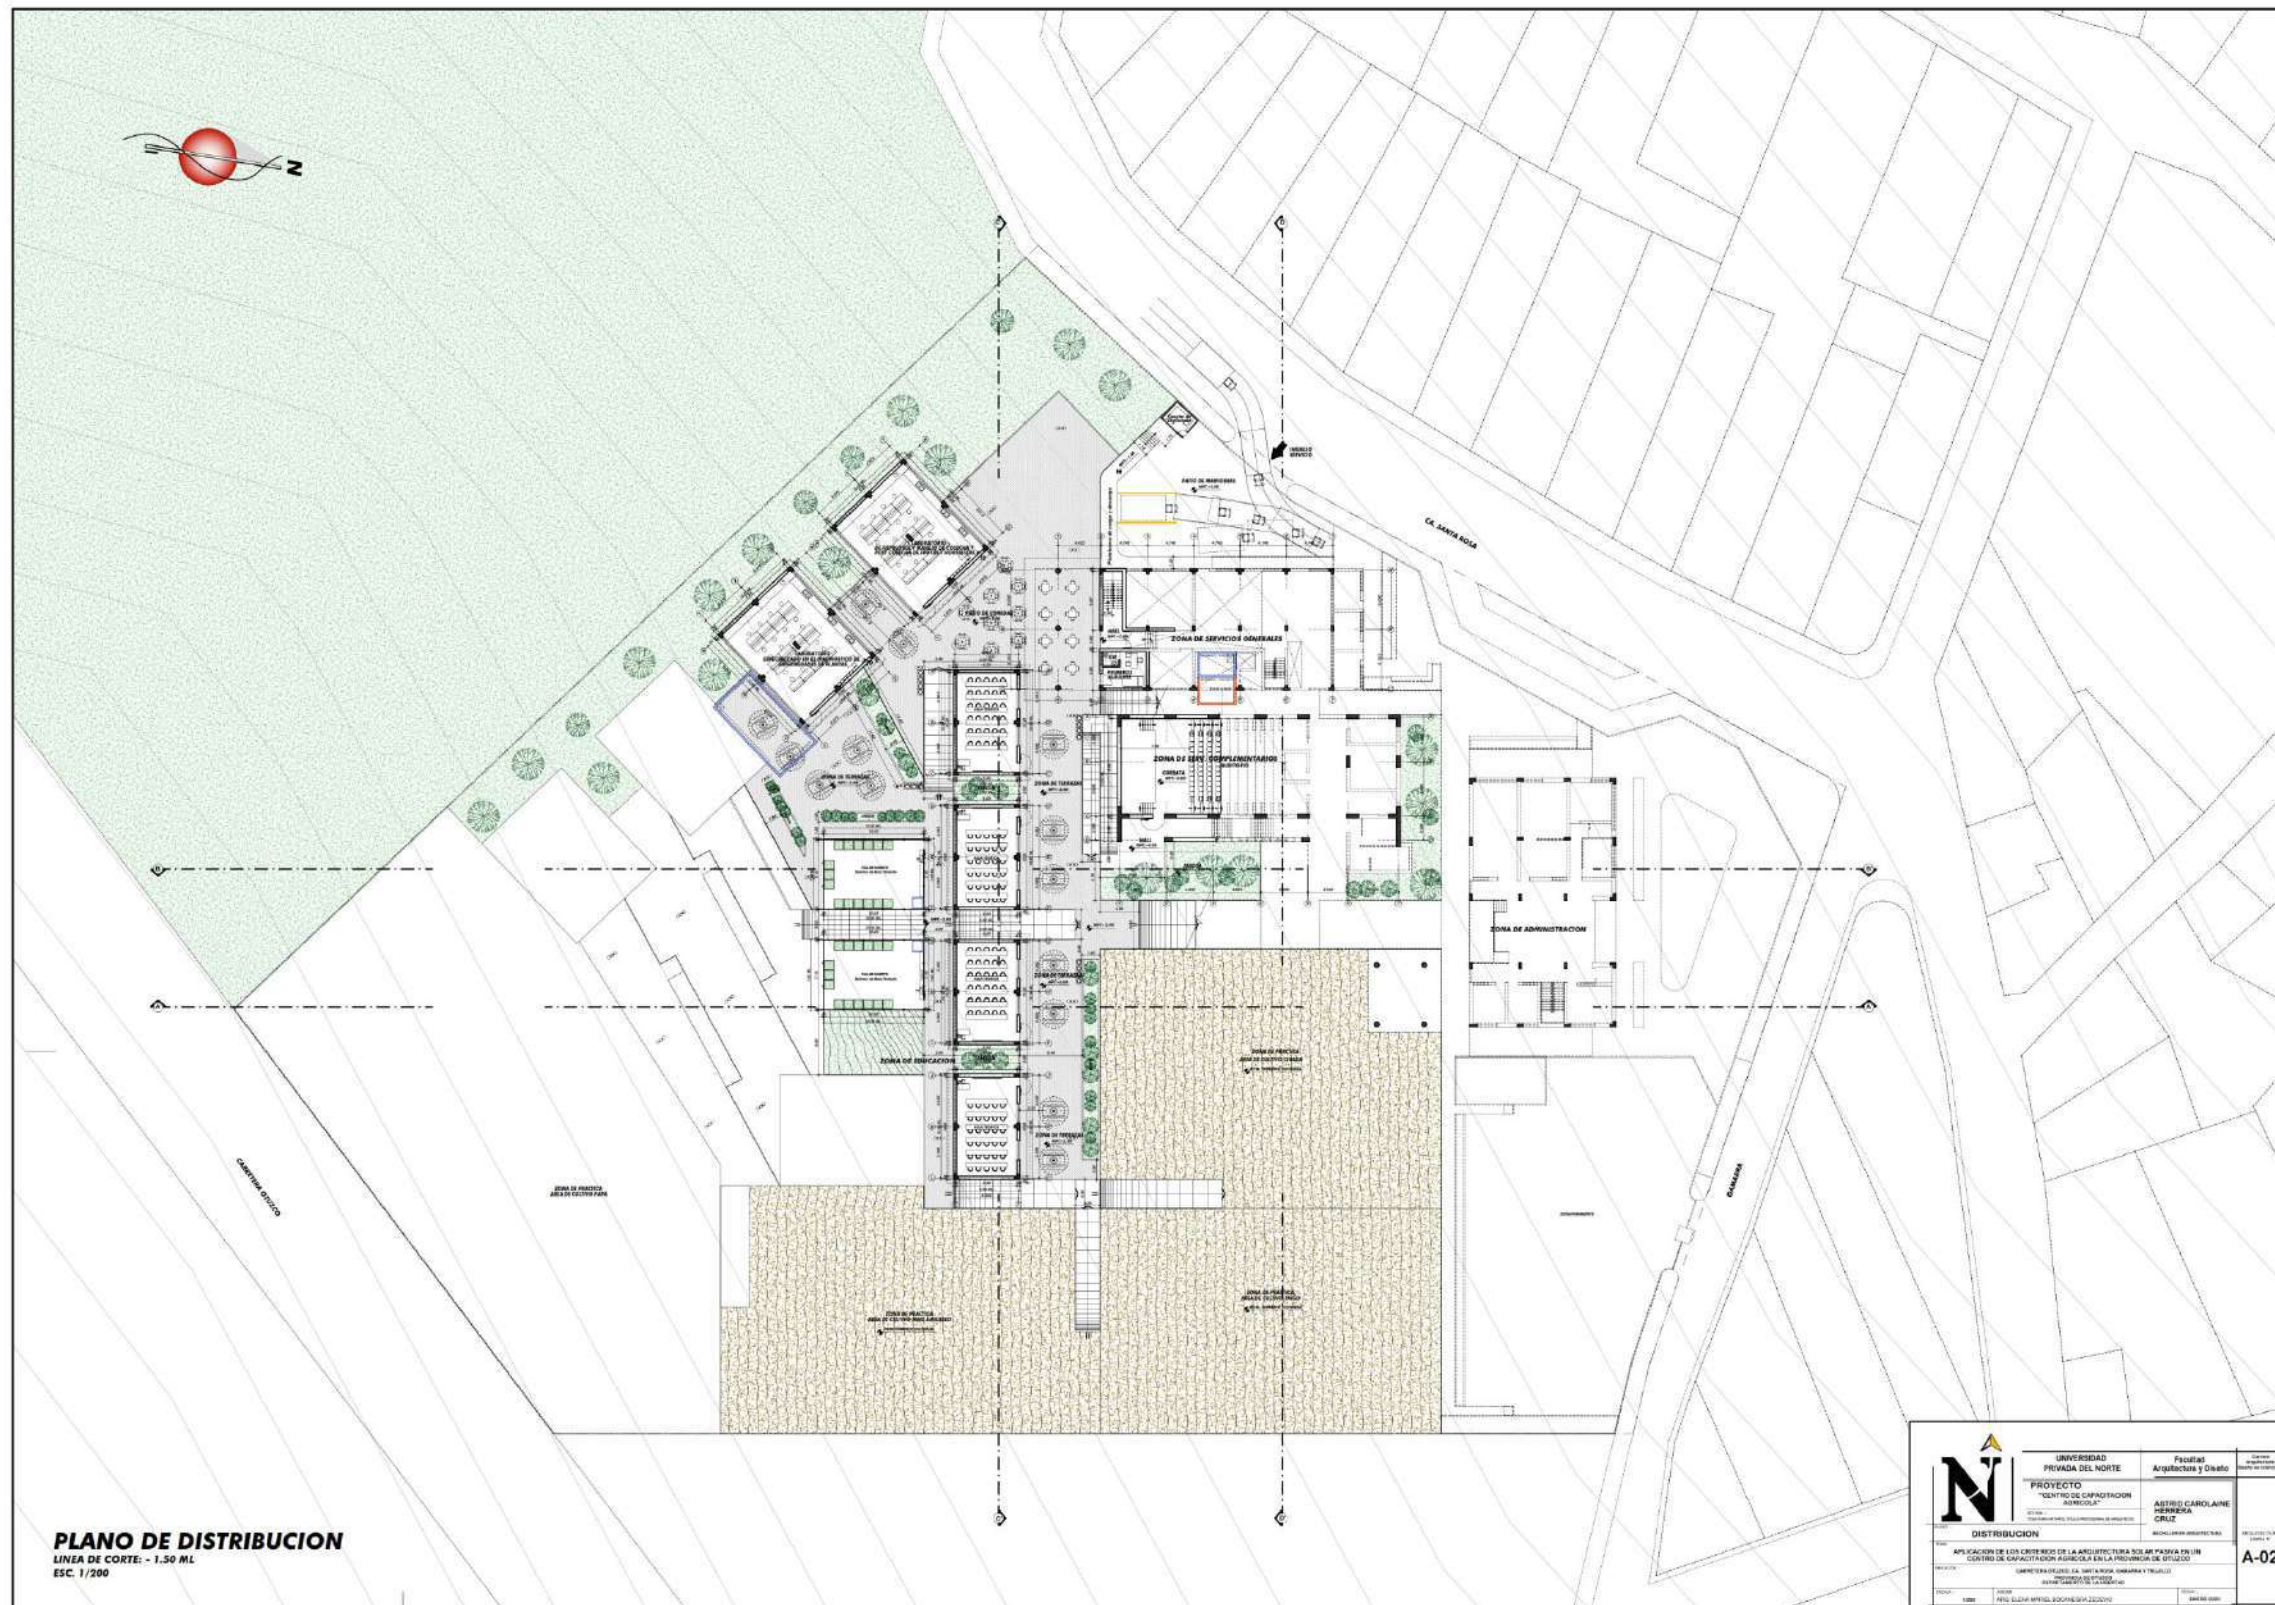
Plano de Distribución. Línea de Corte -1.50 m
